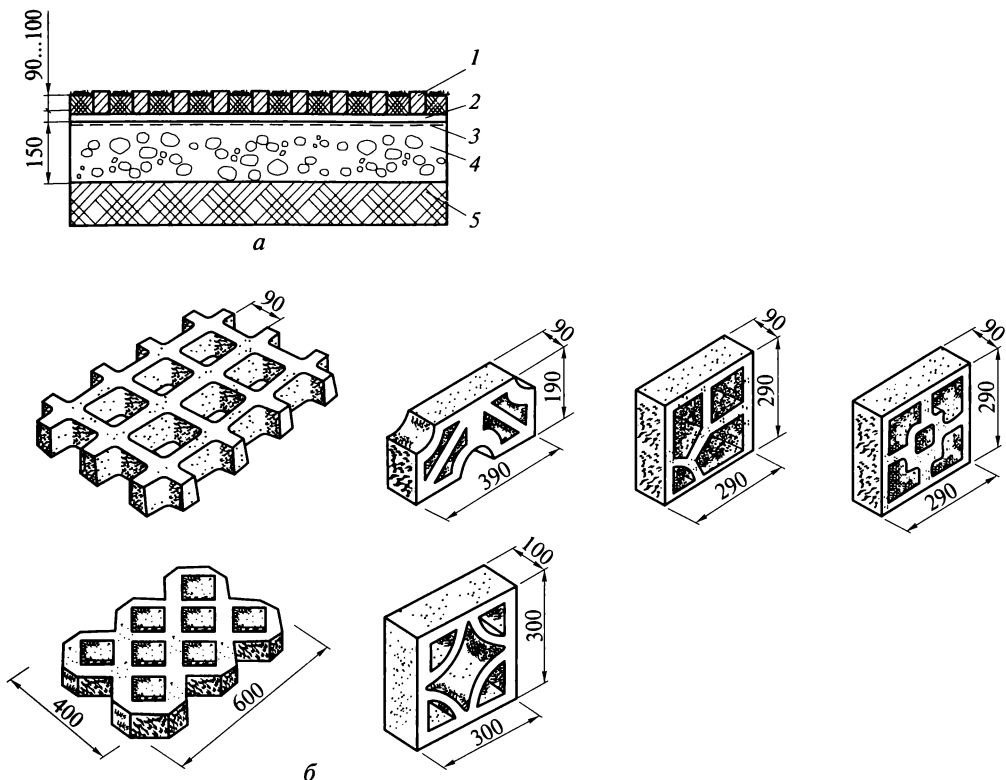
Покрытие из бетонных элементов с вкраплением газона для парковок: *а* — типовая конструкция: 1 — бетонная решетка, смесь растительного грунта с семенами (25%), с мелким щебнем (фракция 4...16 мм); 2 — песок крупный; 3 — геоткань; 4 — щебень; 5 — подготовленное грунтовое основание; *б* — выпускаемые бетонные элементы
